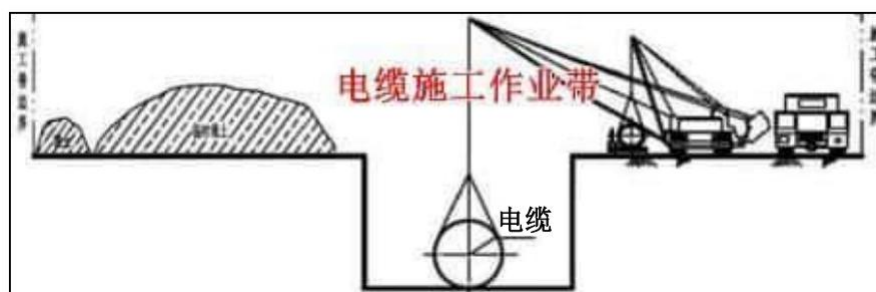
电缆线路沟槽施工作业带施工布置示意图
